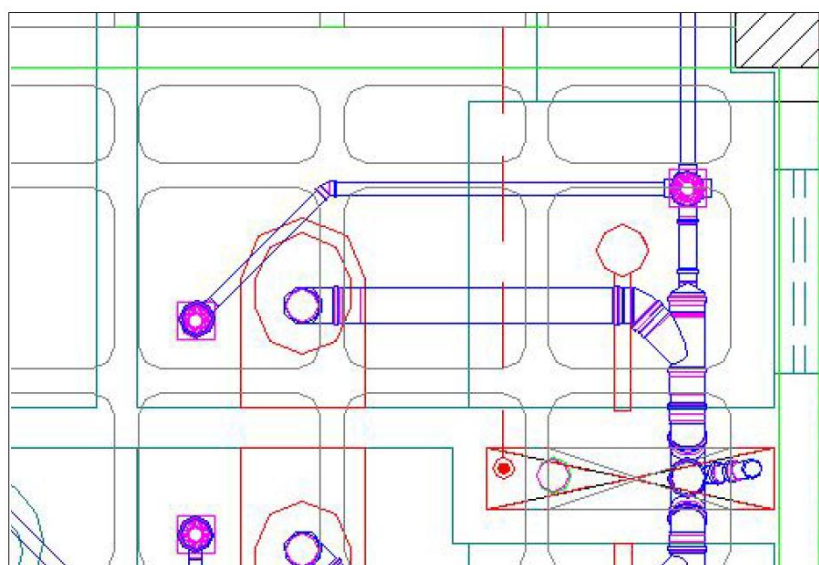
Sifão e coluna de ventilação em conflito com as nervuras da laje, (reproduzido de Sousa, 2010).
